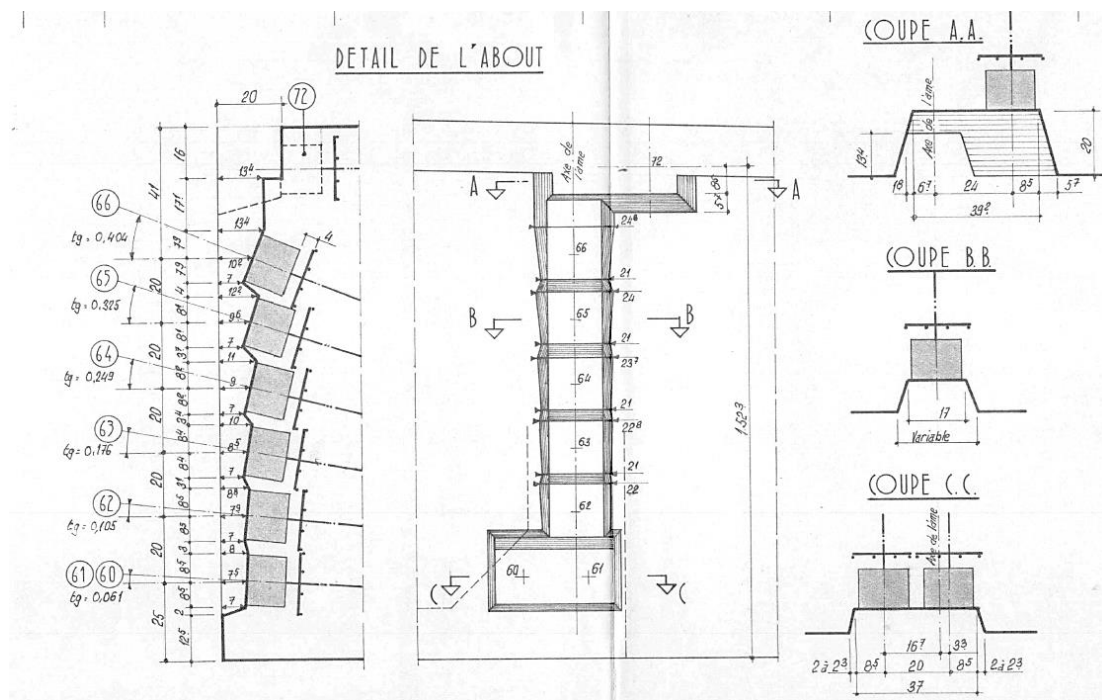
Extrait de plan de câblage – Élévation de l'about
